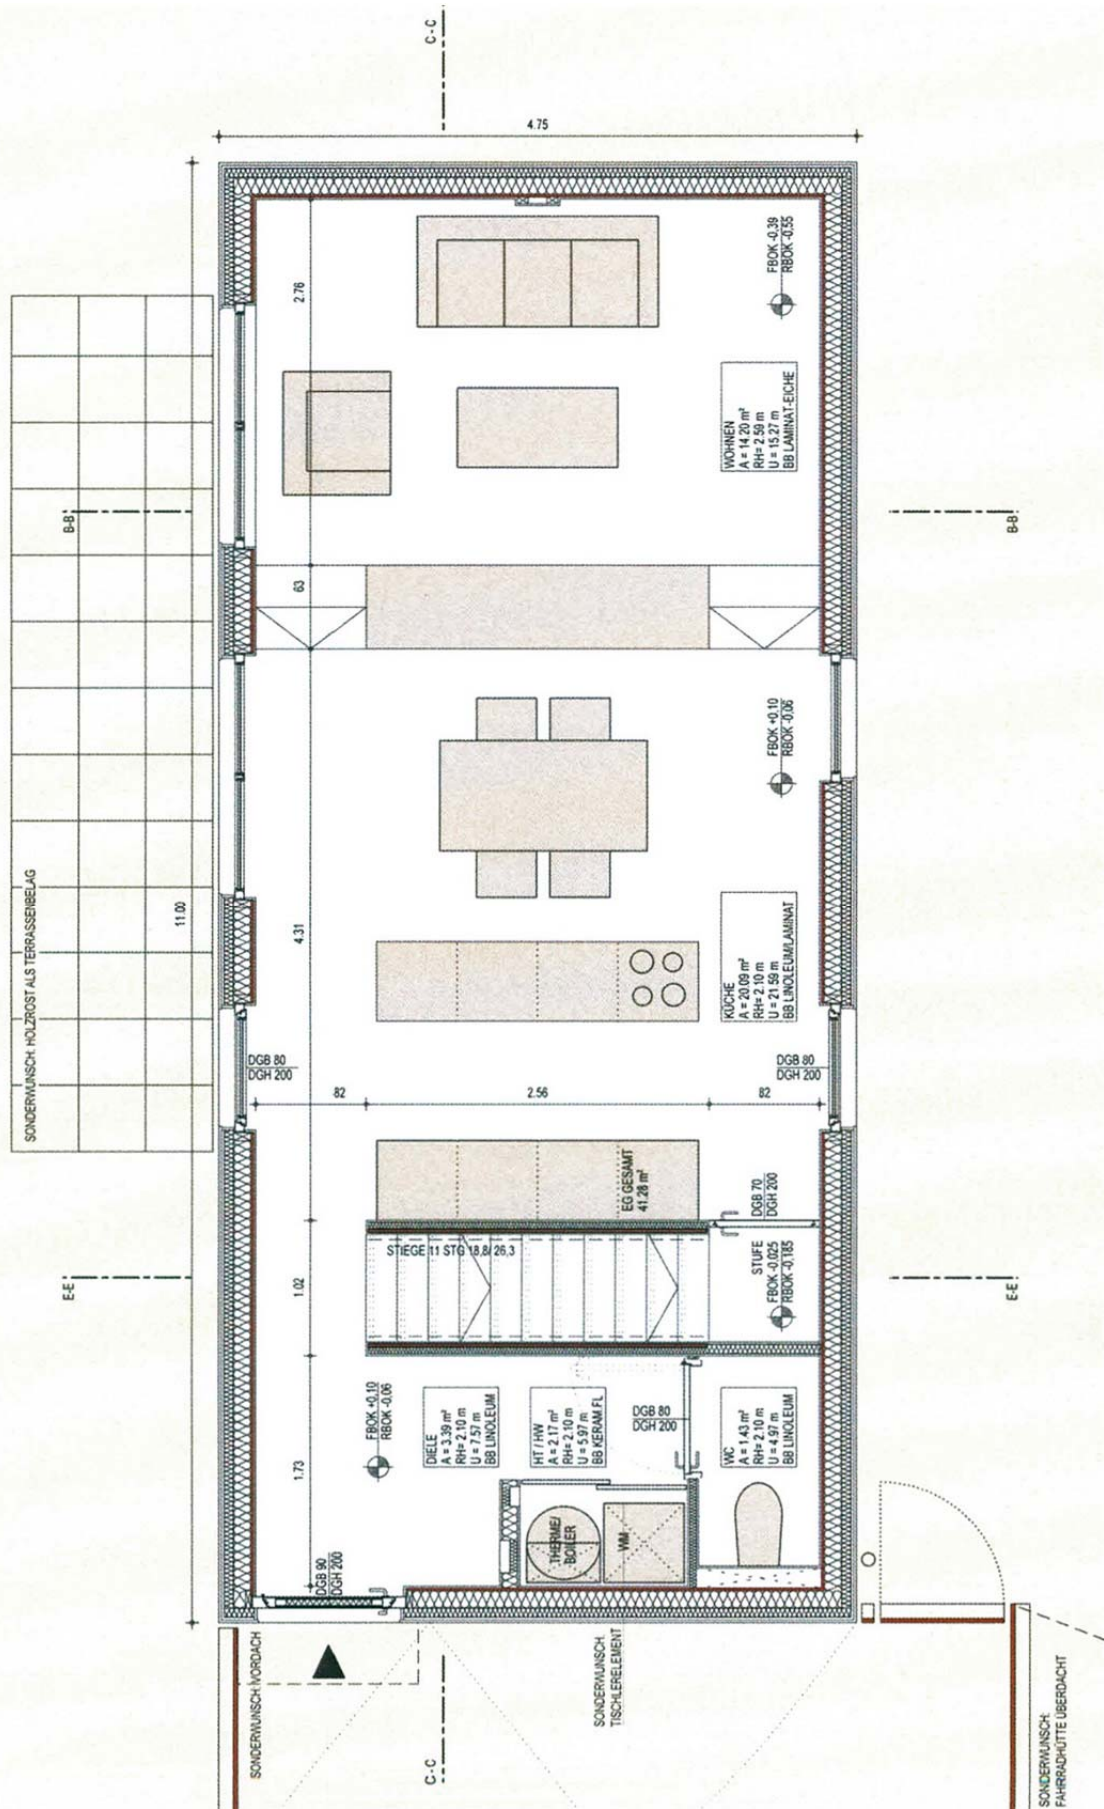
Grundriss Erdgeschoss _ Typ A ohne Keller
